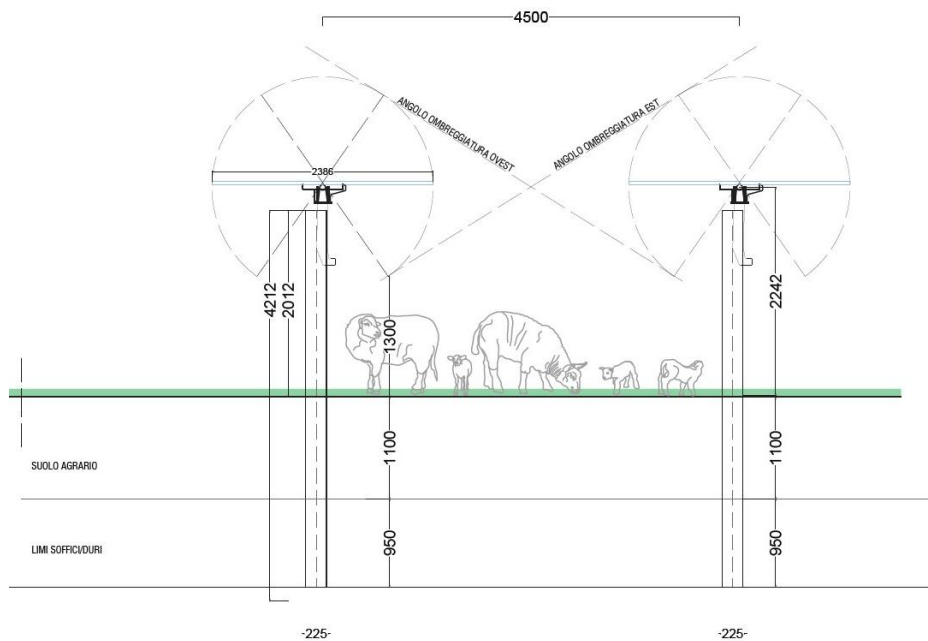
Sezione trasversale tracker in area ad attività zootecnica
